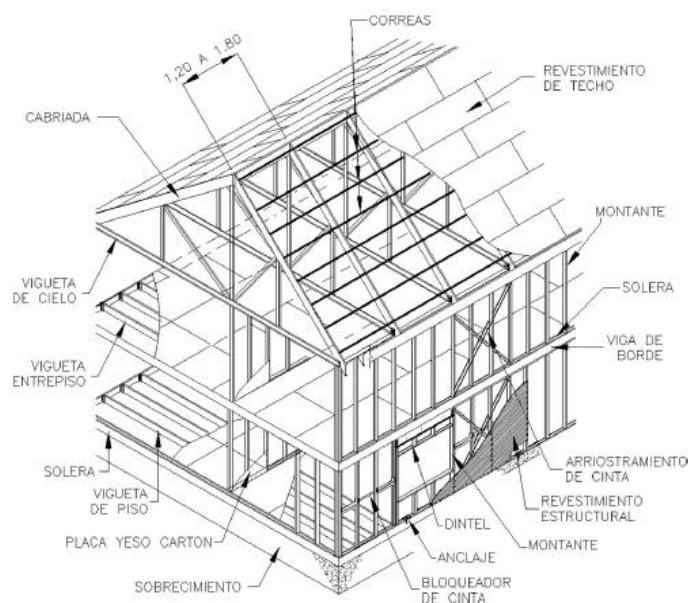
Vivienda de dos niveles en steel framing, recuperado de manual de ingeniería de steel framing, por
